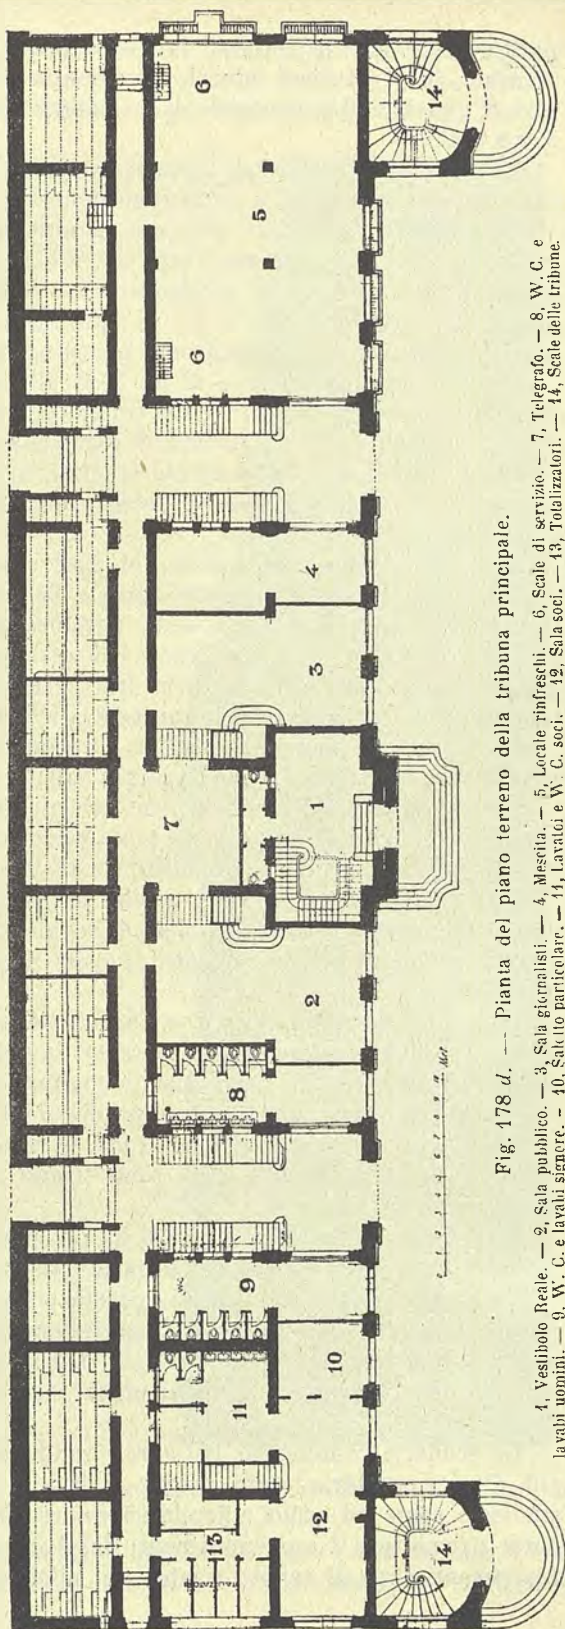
d. — Pianta del piano terreno della tribuna principale.
